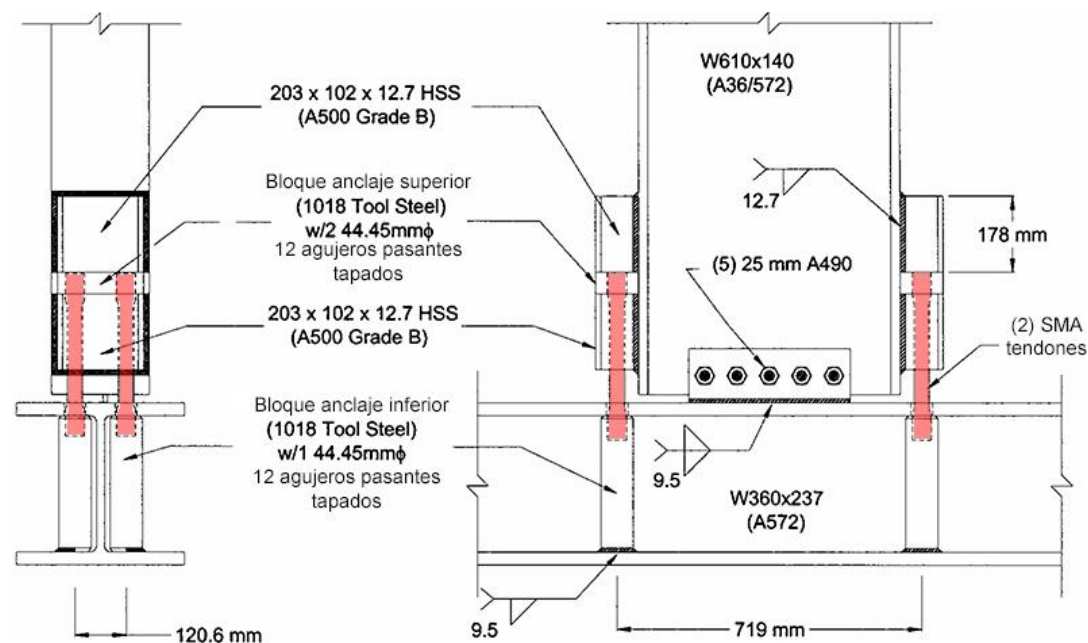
Conexión entre soporte y viga metálicos mediante tendones SMA.
